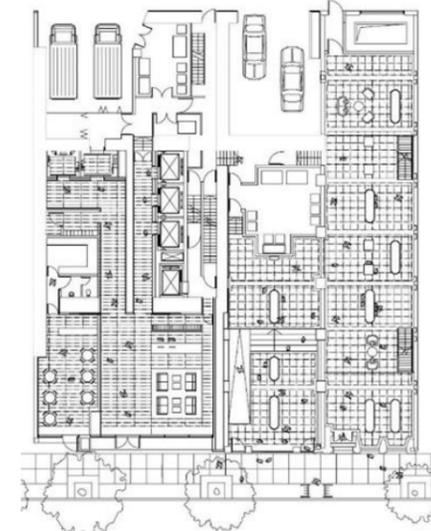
Plan RDC de Jameson House. (source : Google image)
